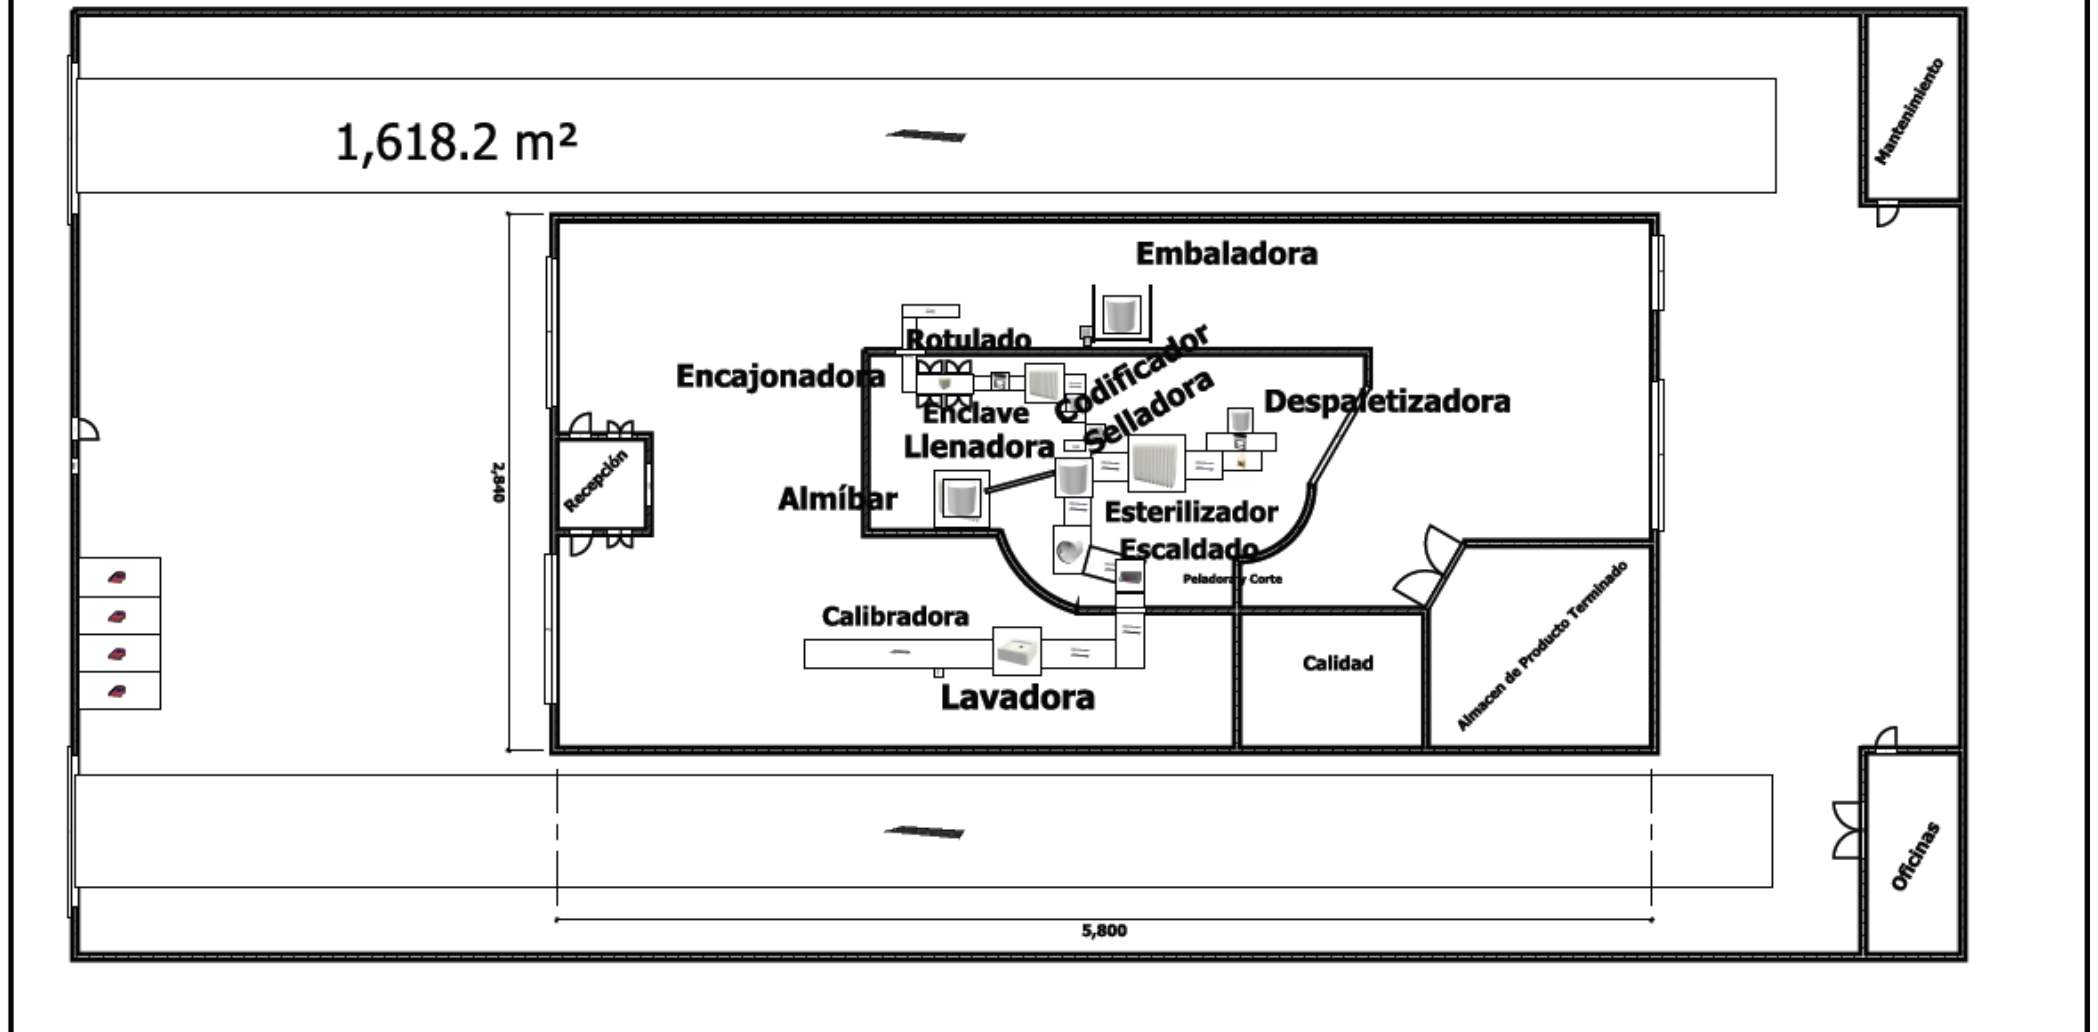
Plano de Distribución en Planta Fuente (Elaboración Propia)
